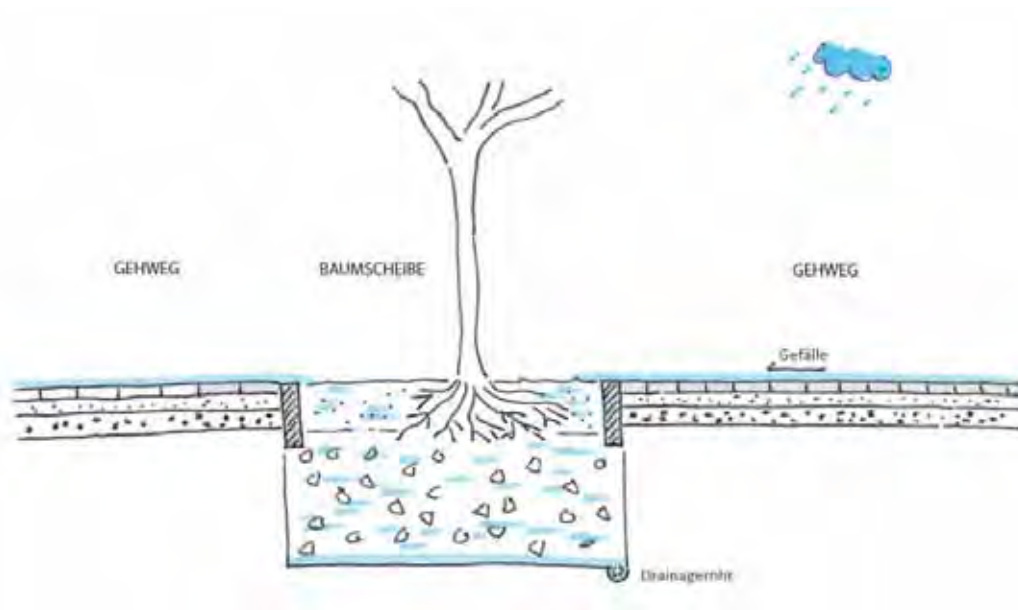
Typ 1a – Pflanzgrube mit oberirdischem Wasserzufluss und offener Baumscheibe (für unbedenkliche Regenabflüsse gemäß DWA-A 138) (Quelle: Elke Kruse)
